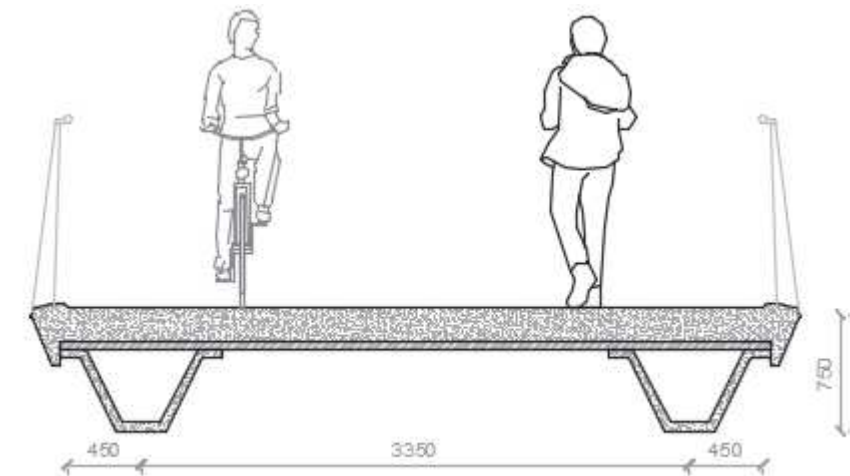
Solución C: Tablero bijácena de hormigón. Cotas en mm
